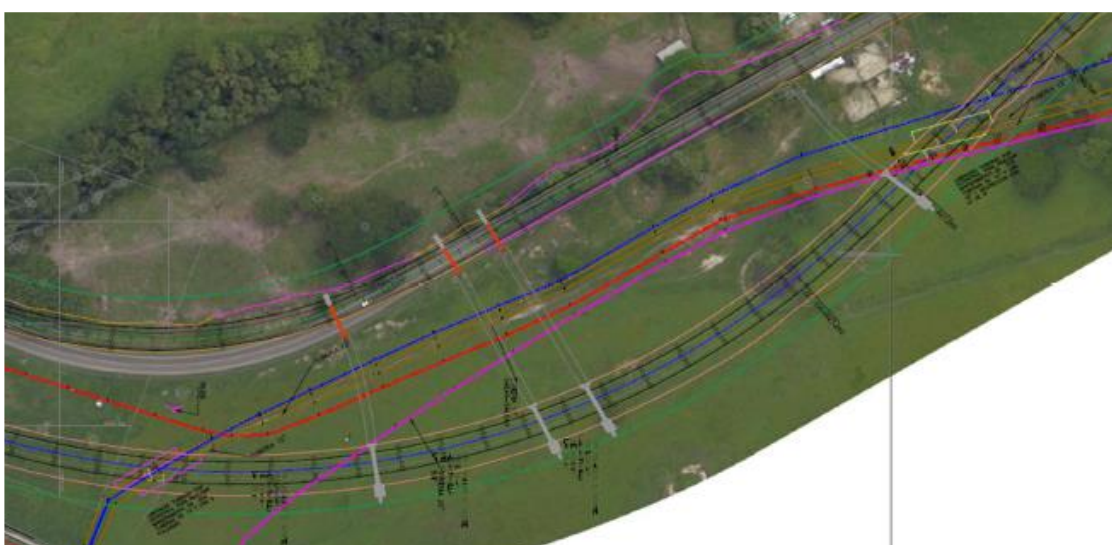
Acercamientos críticos con estructuras viales (Puentes) e infraestructura petrolera
